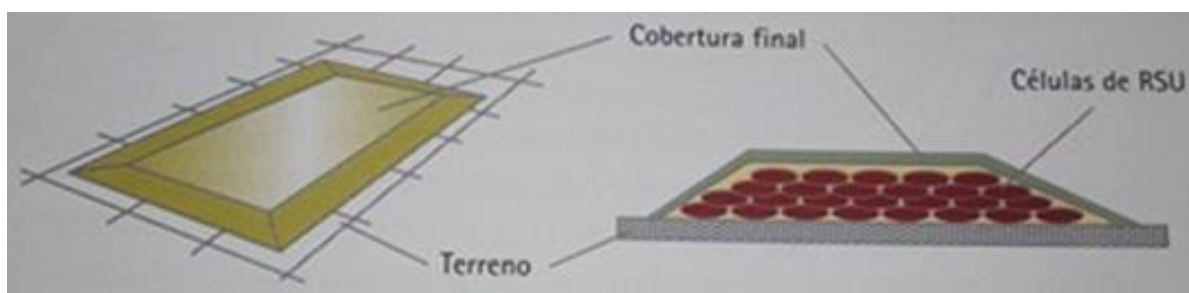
Esquema em planta e em corte de um aterro em extensão (adaptado de Cabeças & Levy, 2006).
